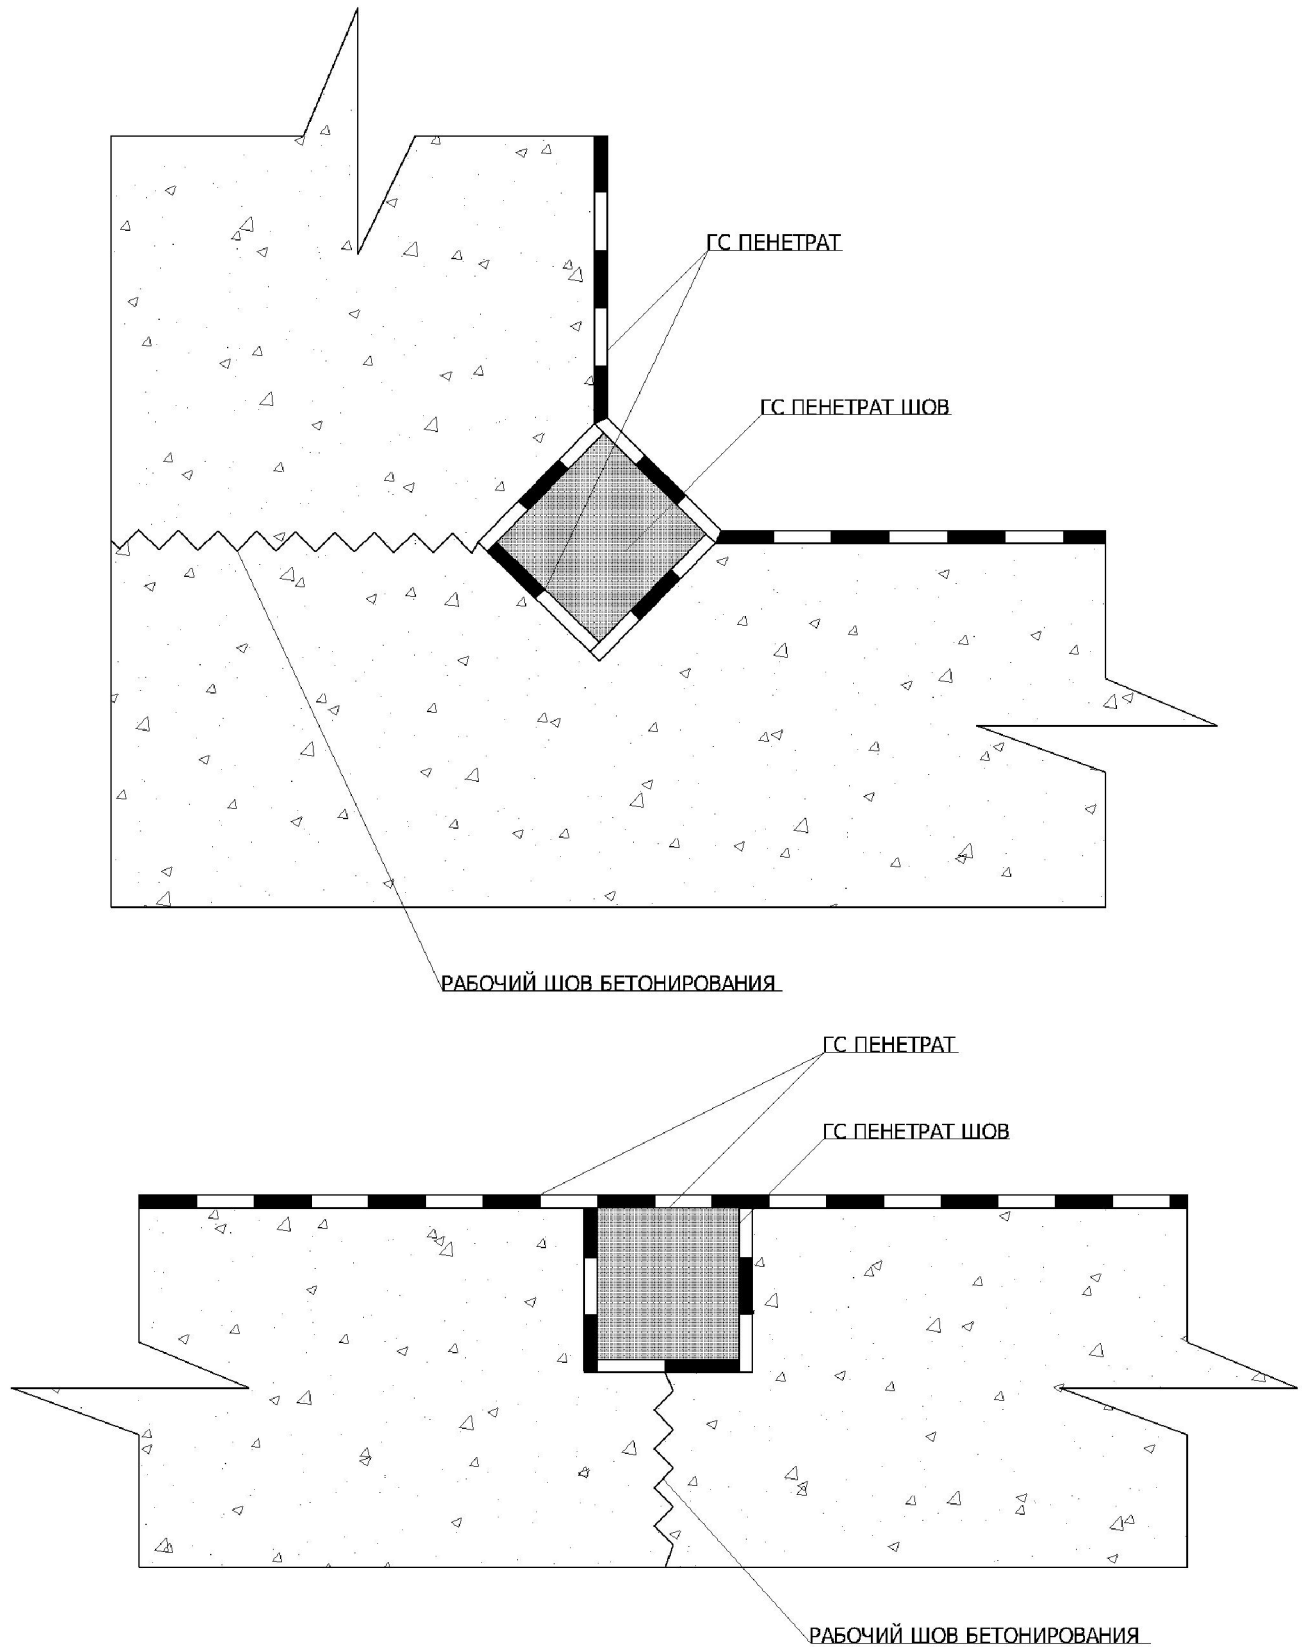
Устройство гидроизоляции рабочих швов бетонирования
